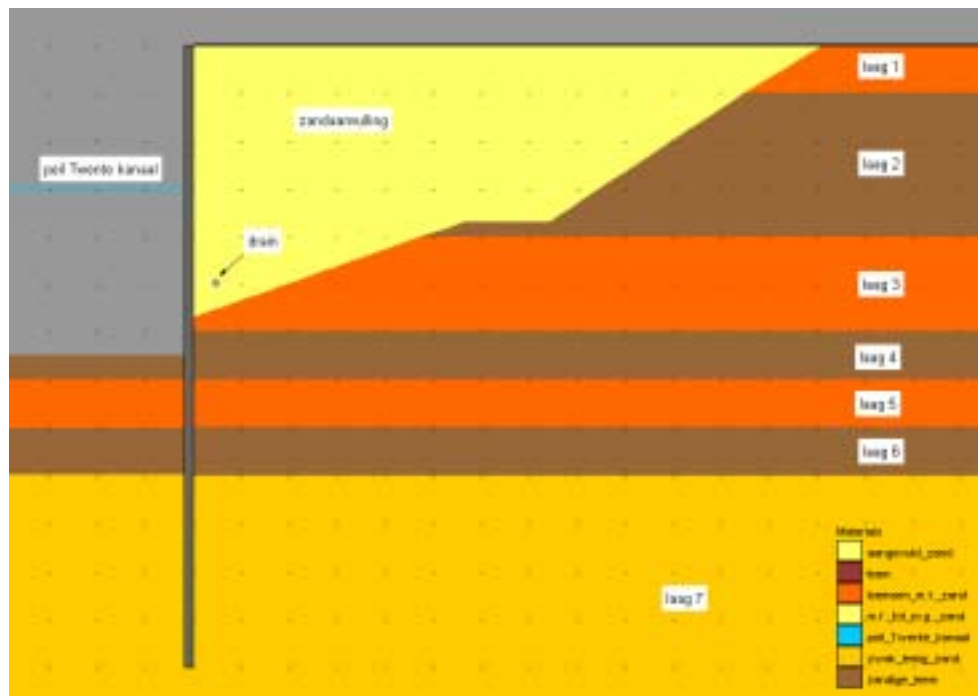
Modelopbouw van het CTrT-terrein met nieuwe damwand, zandaanvulling en 200 mm drain. De 7 bovenste modellagen zijn ook zichtbaar. De oude kademuur is verwijderd.
